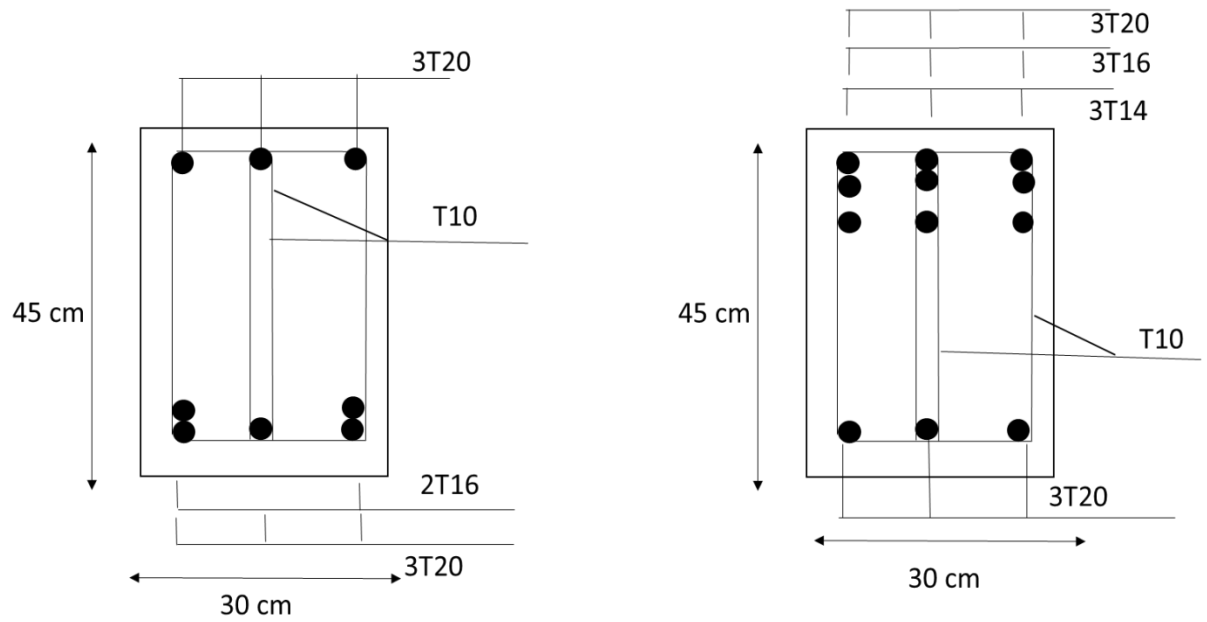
Schéma de ferrailage de poutre secondaire 30x45 (habitation).
